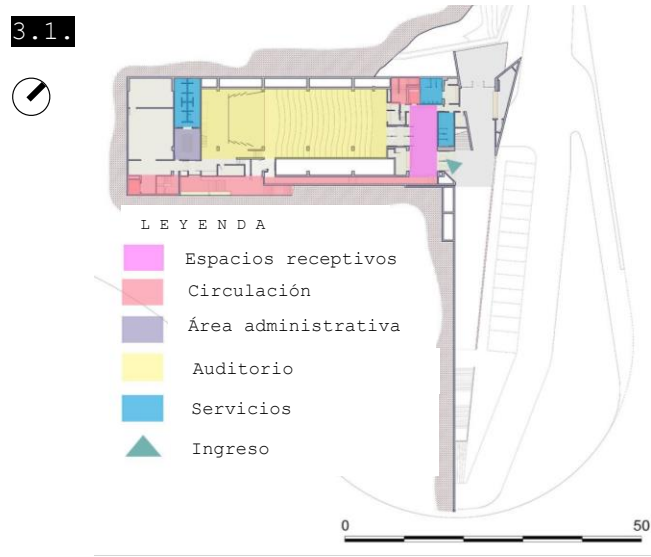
Planta del auditorio. (redfundamentos, 2014)
